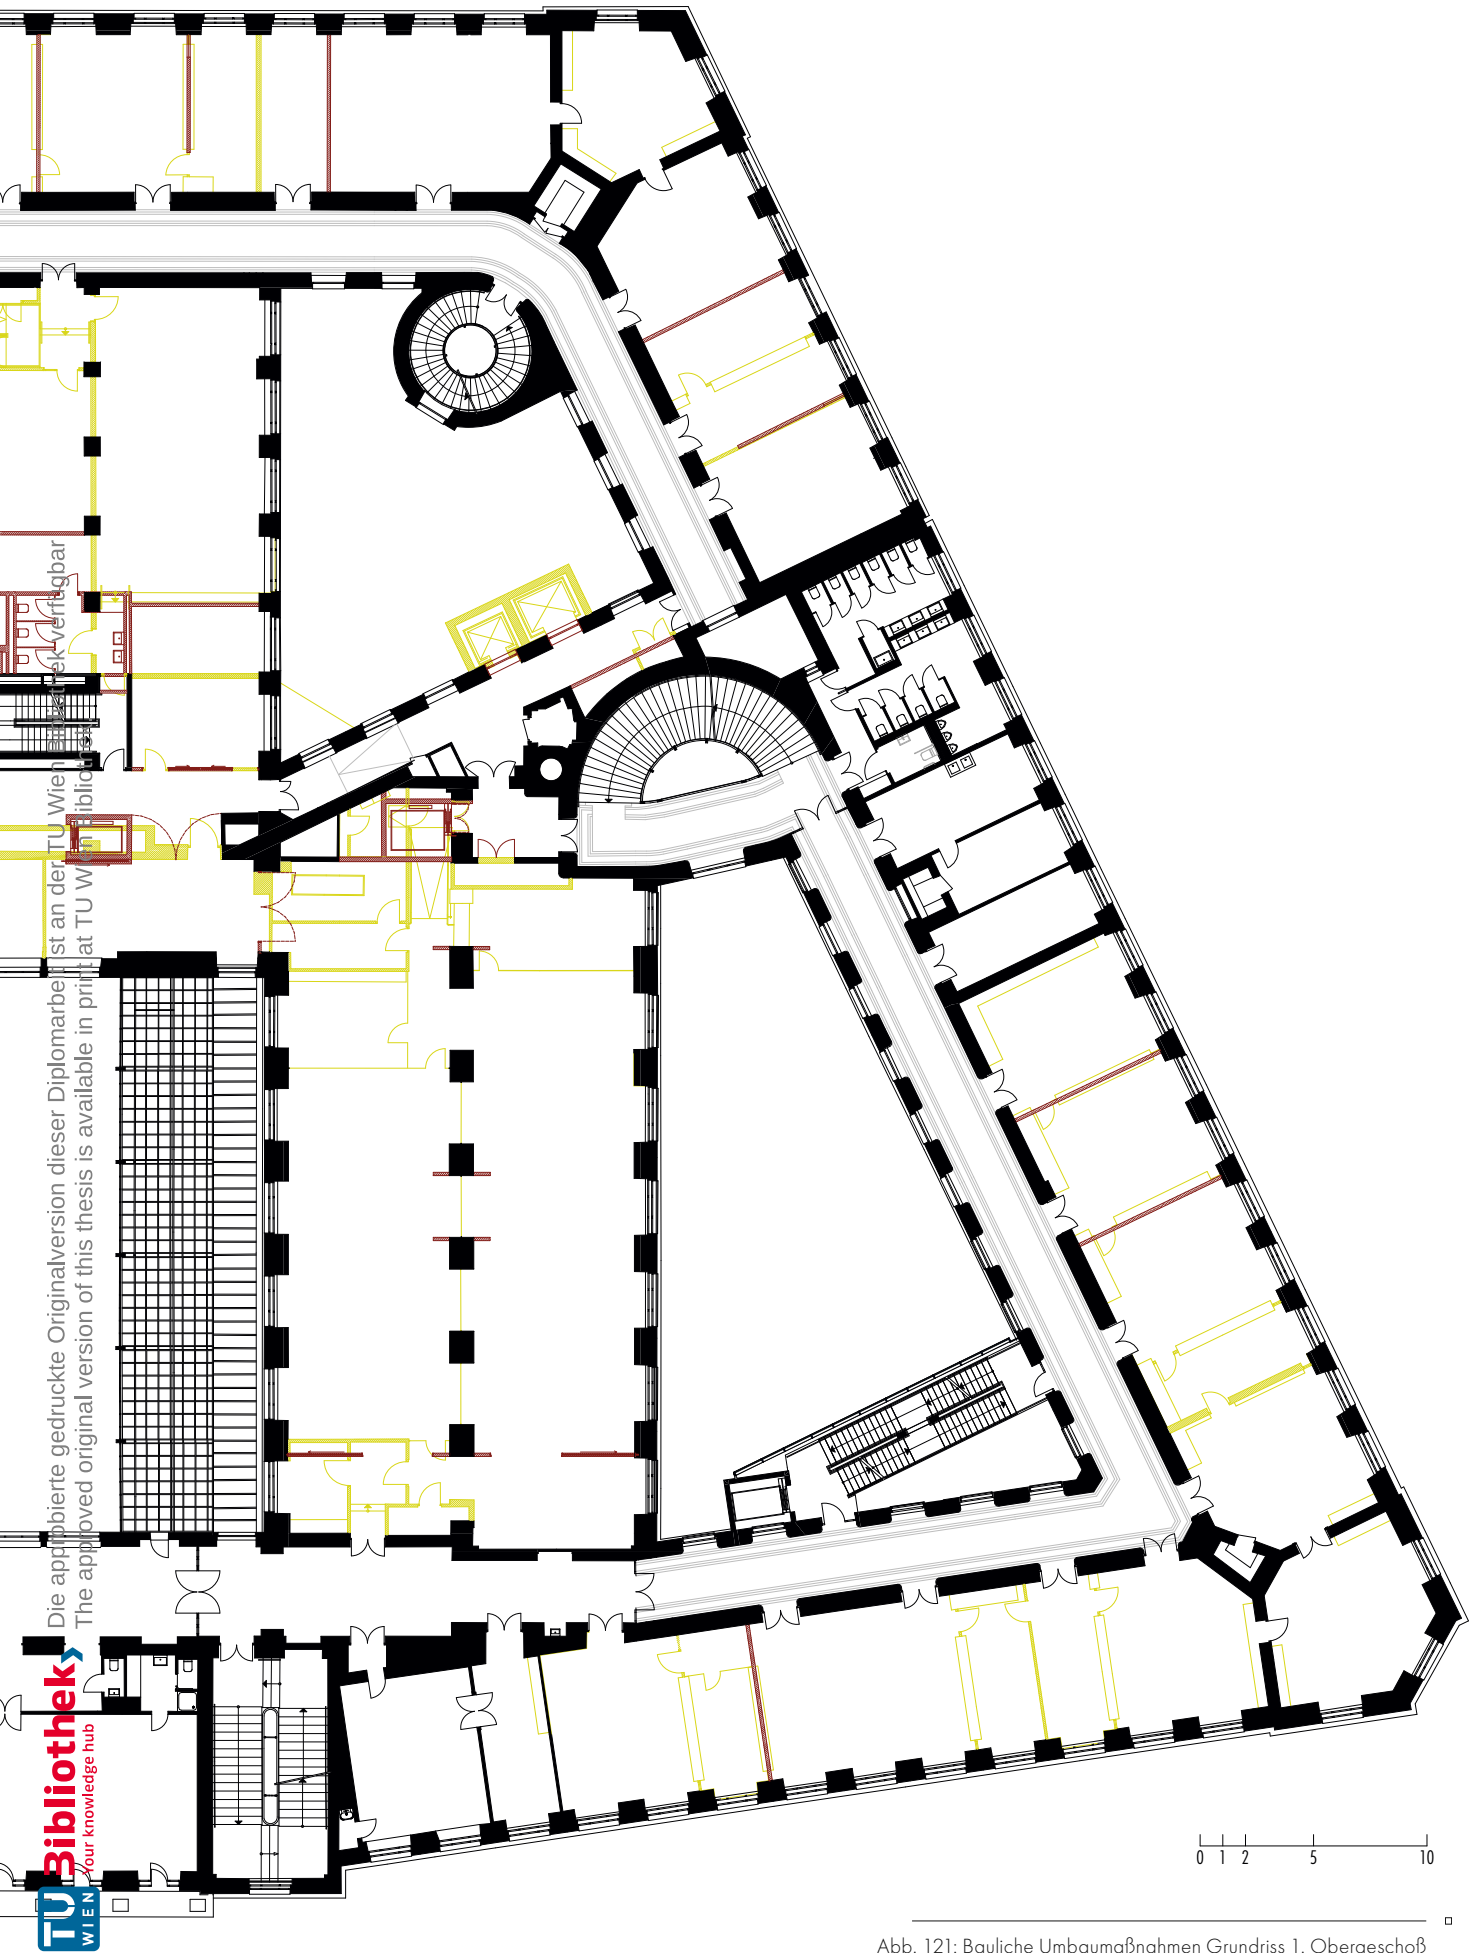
Bauliche Umbaumaßnahmen Grundriss 1. Obergeschoß
